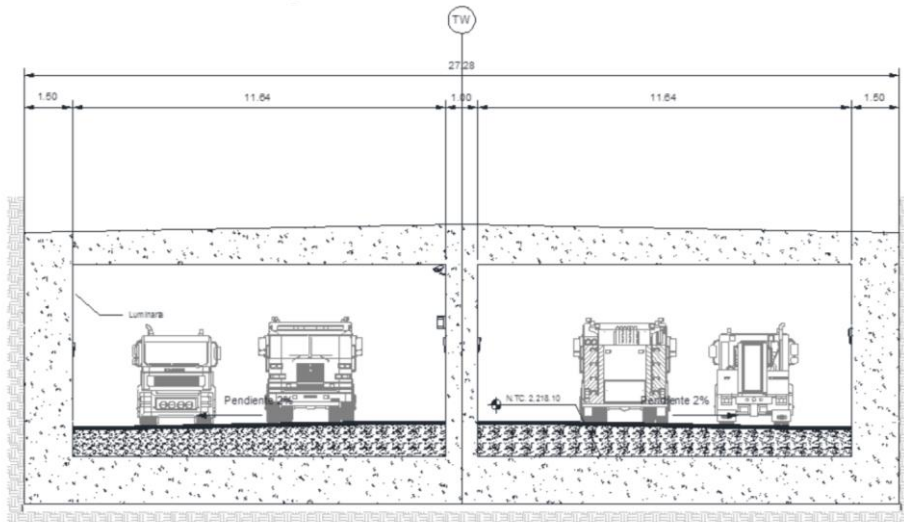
Sección en cajón con muro intermedio, túneles GSE Este (TASANA, 2016)
